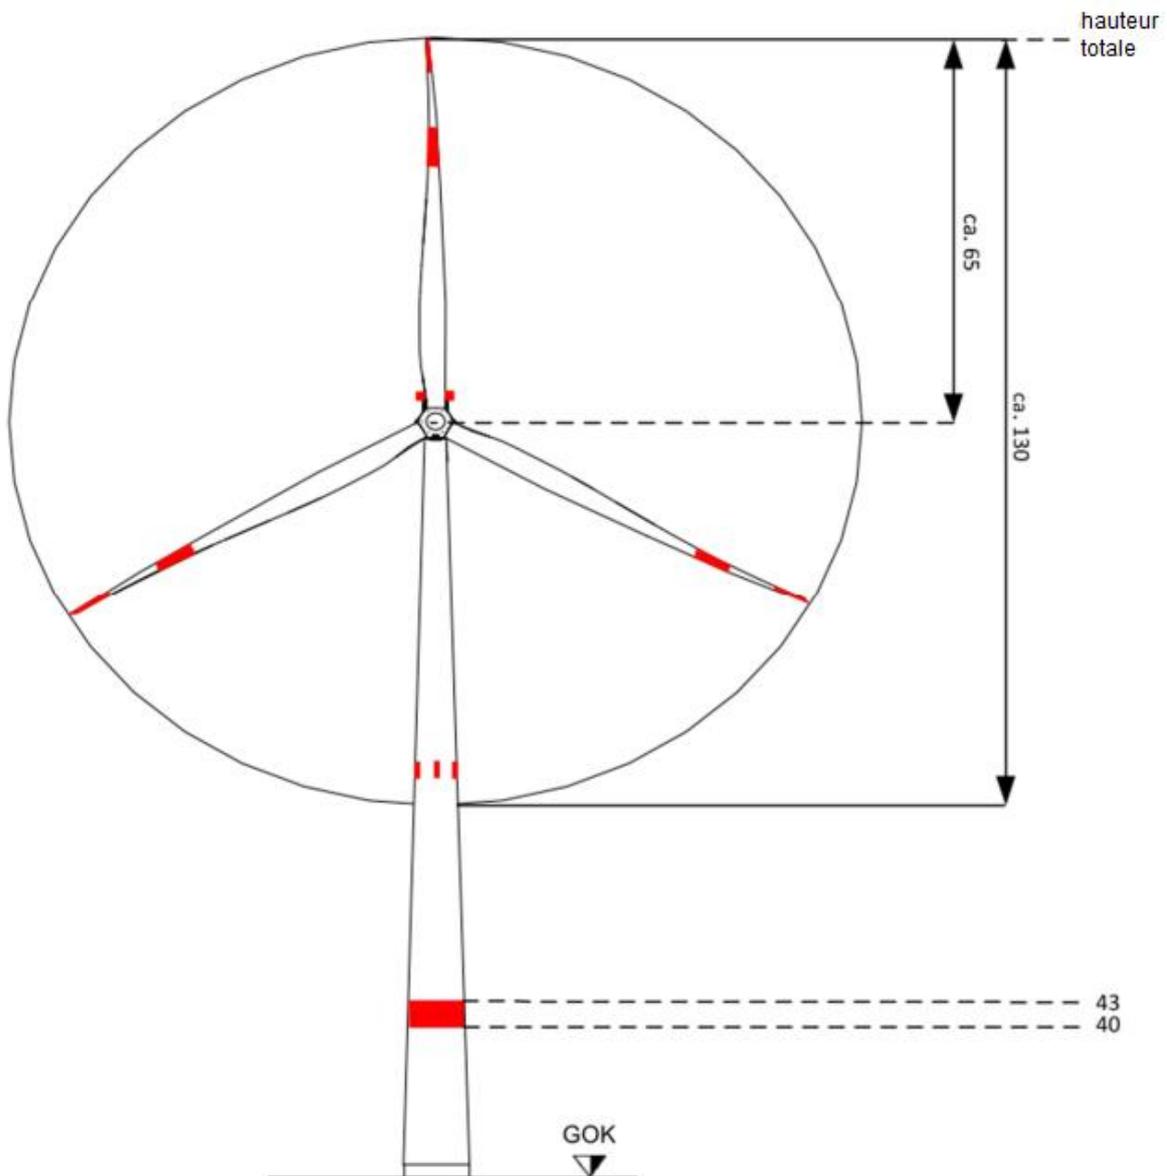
115 & 135 m de hauteur de moyeu, vue frontale
